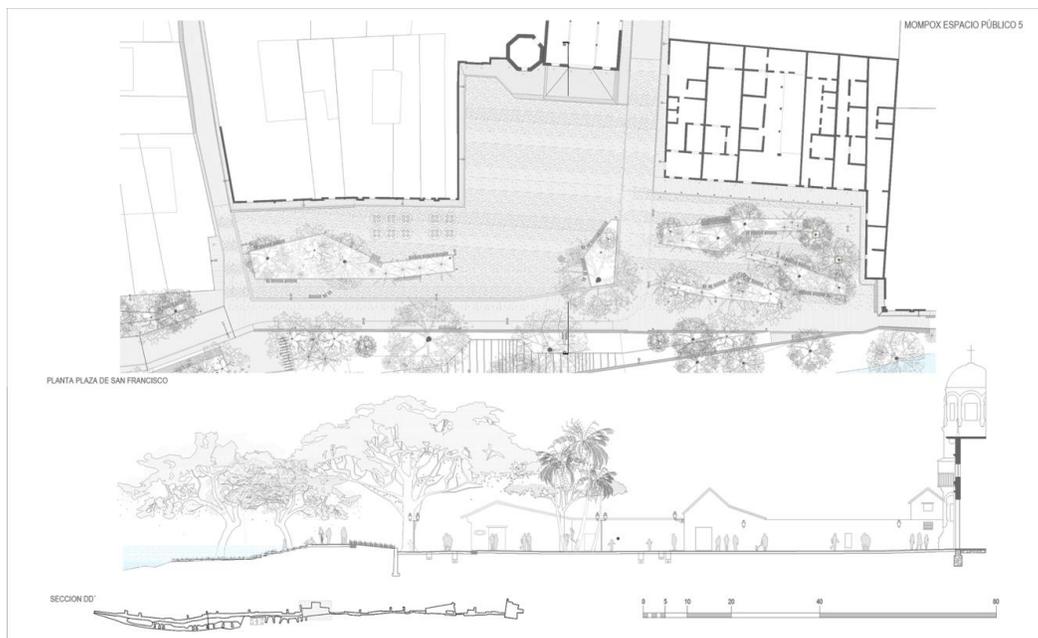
Planta proyecto Mompox <https://www.archdaily.co/> 2023
